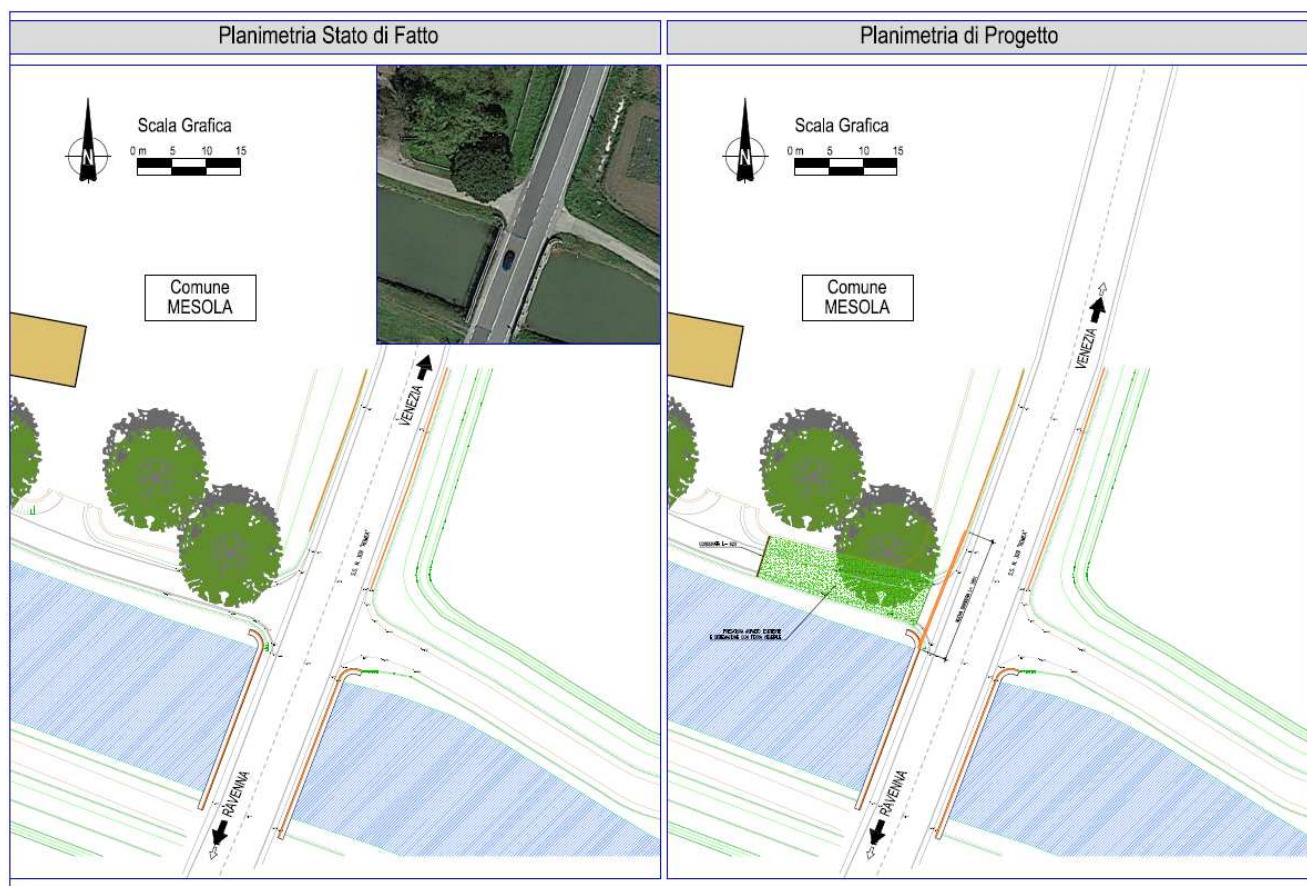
Intervento n°24 – Planimetria Stato di fatto - Progetto
